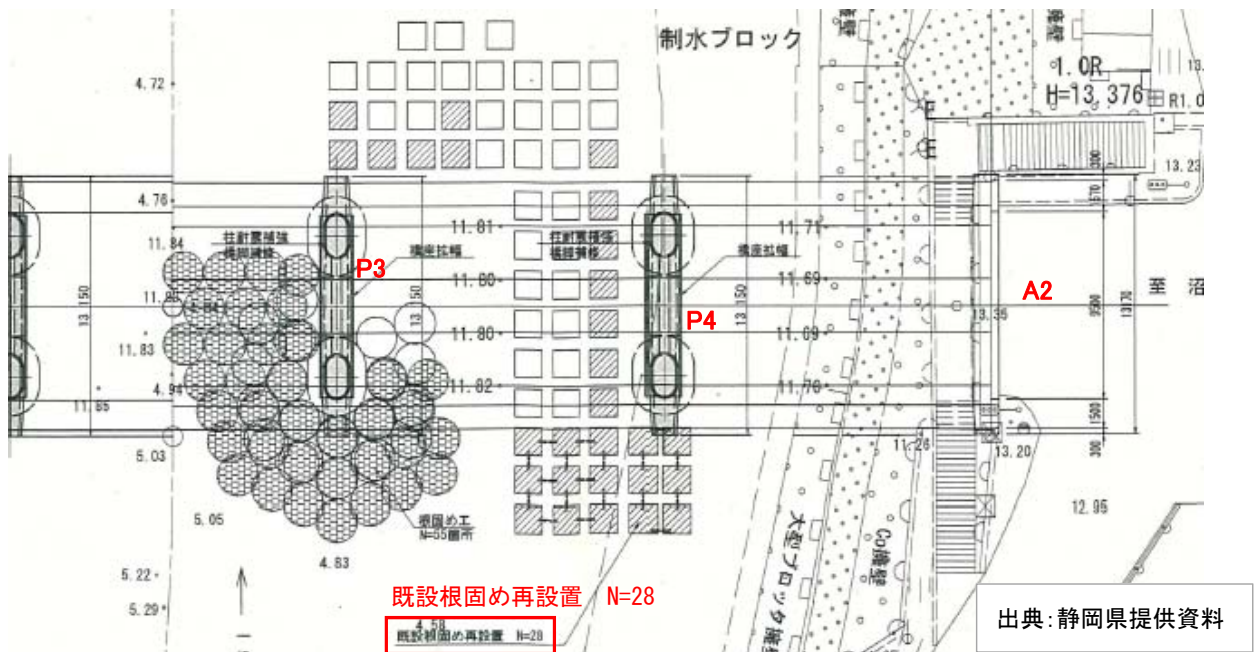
平成 25 年度 黄瀬川大橋橋脚補強工 平面図
